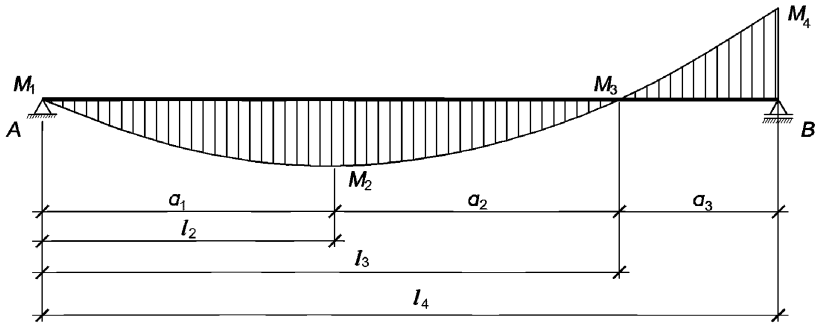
Схема расположений расчетных сечений при расчете на сдвигающее усилие на эпюре моментов
